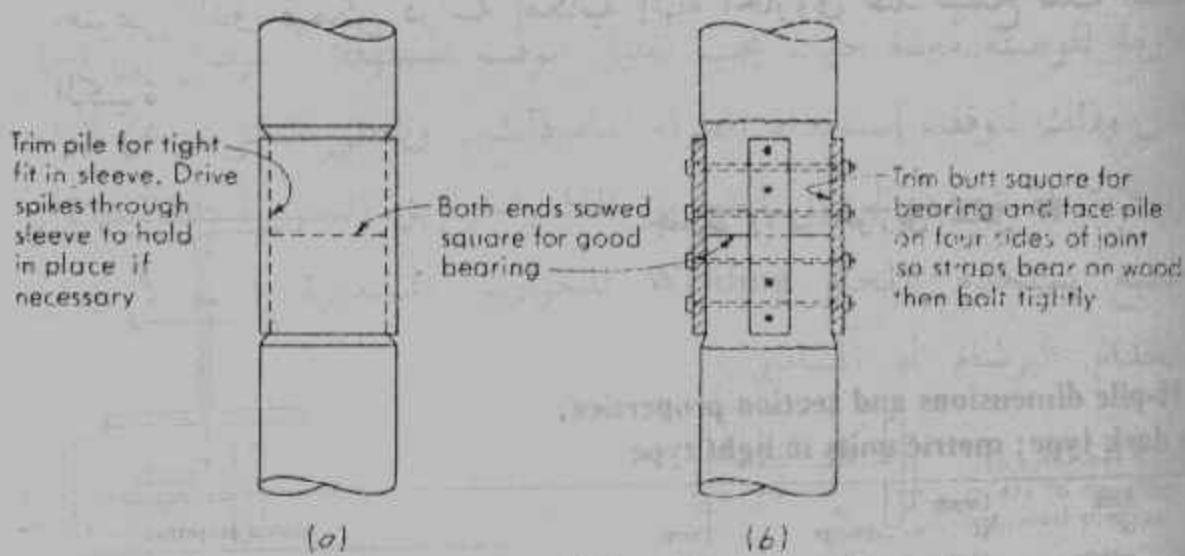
حماية الخازوق الخشبي وشكل الخازوق
